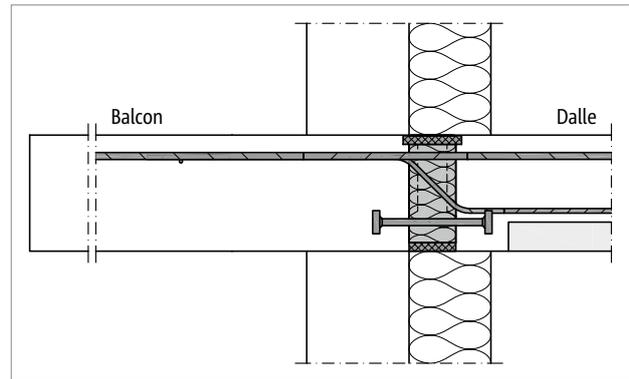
Schöck Rutherma® T type DB : liaison pour façade en béton armé et plancher constitué de prédalles
